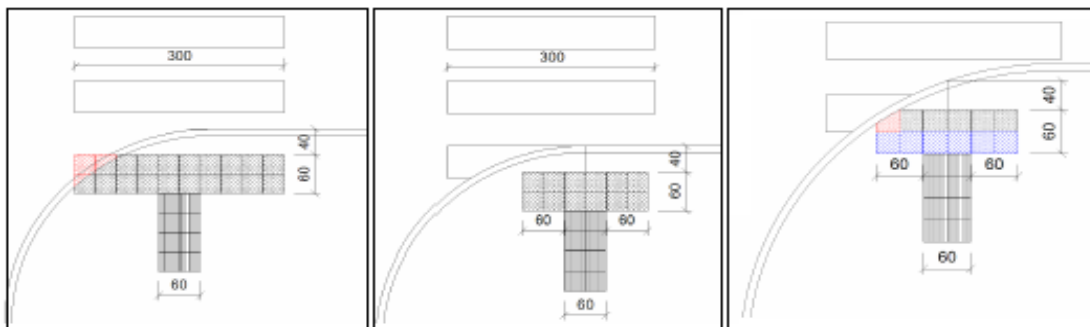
Disposition des dalles de repérage cas de traversées dans les courbes.
